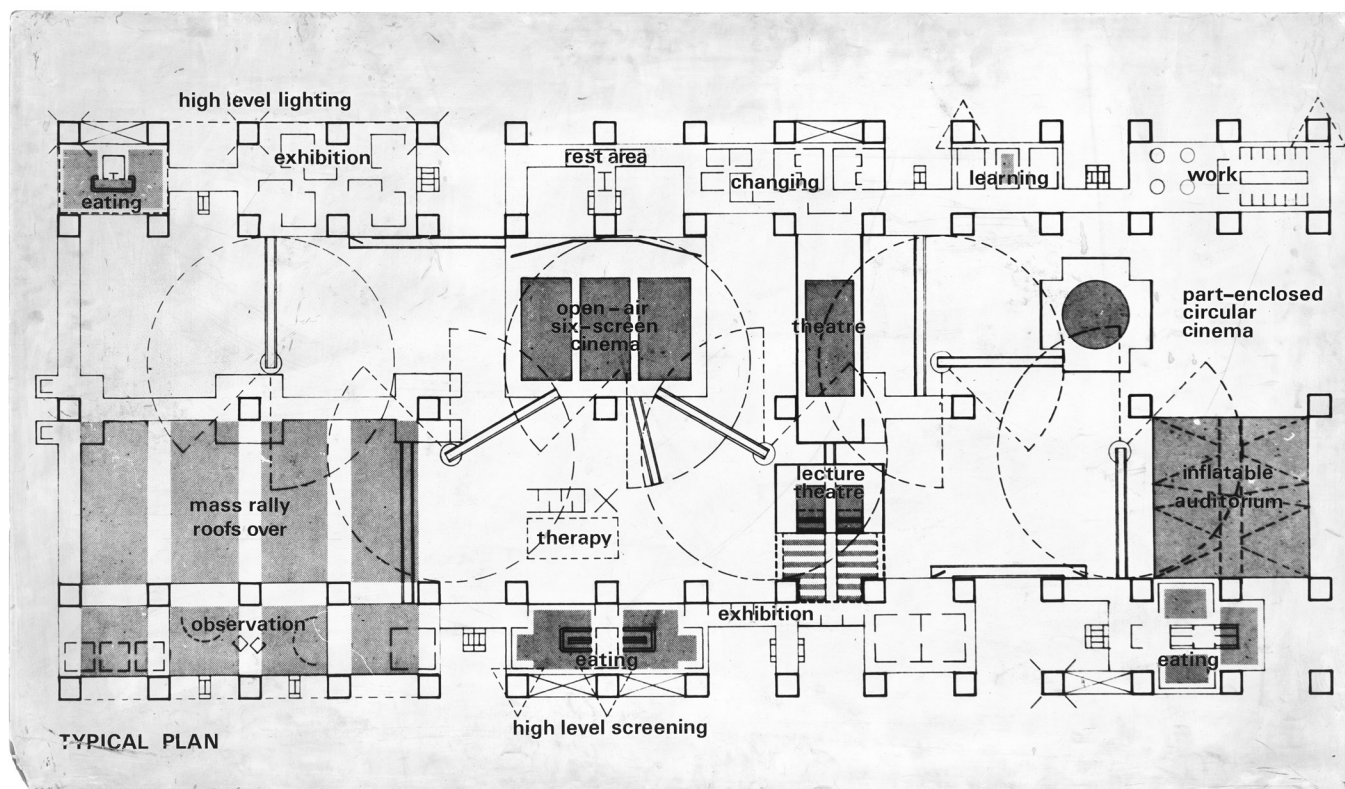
Esquema en planta del proyecto para el Fun Palace. Fuente: Cedric Price fonds. Canadian Centre for Architecture.
